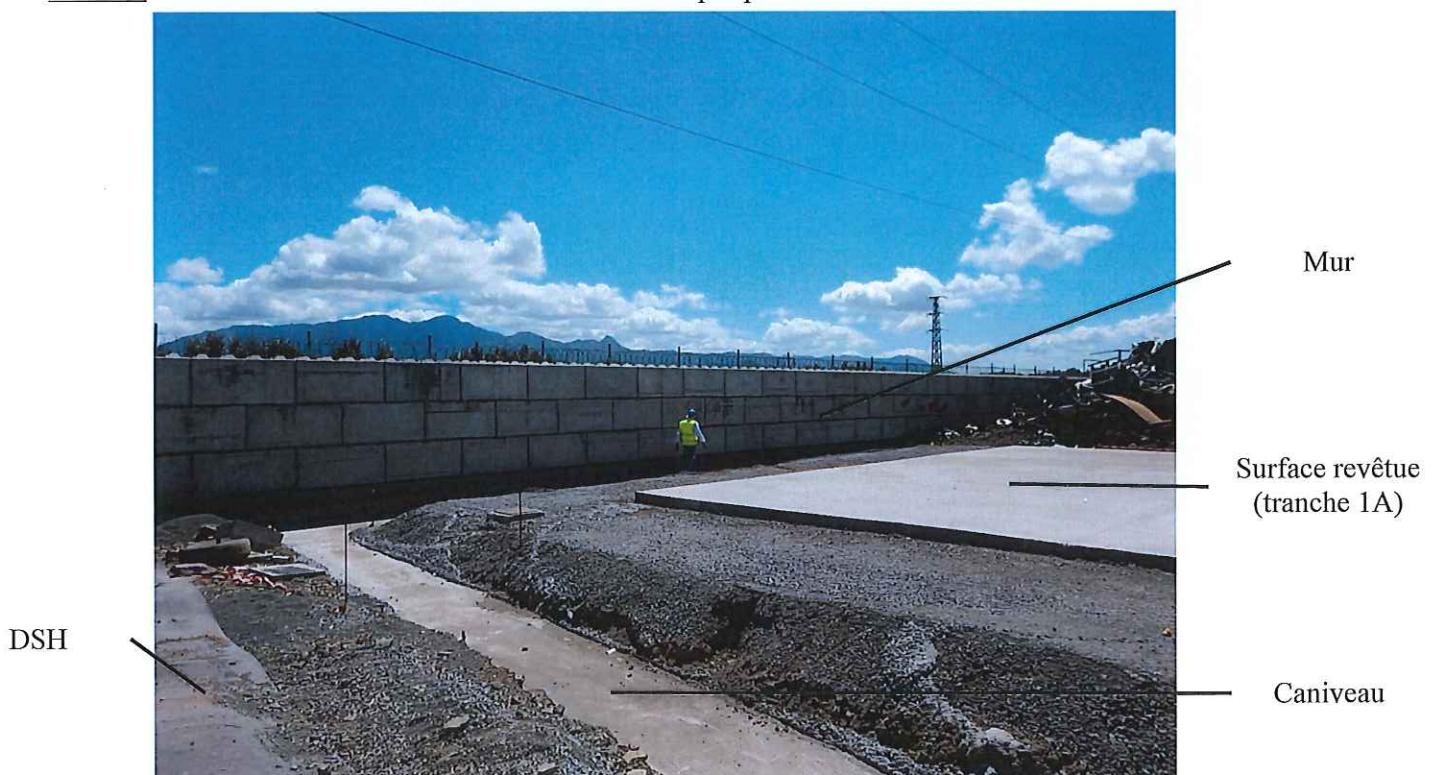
couverture horizontale de la zone de la tranche 1A (vue en direction du Nord-Ouest)
